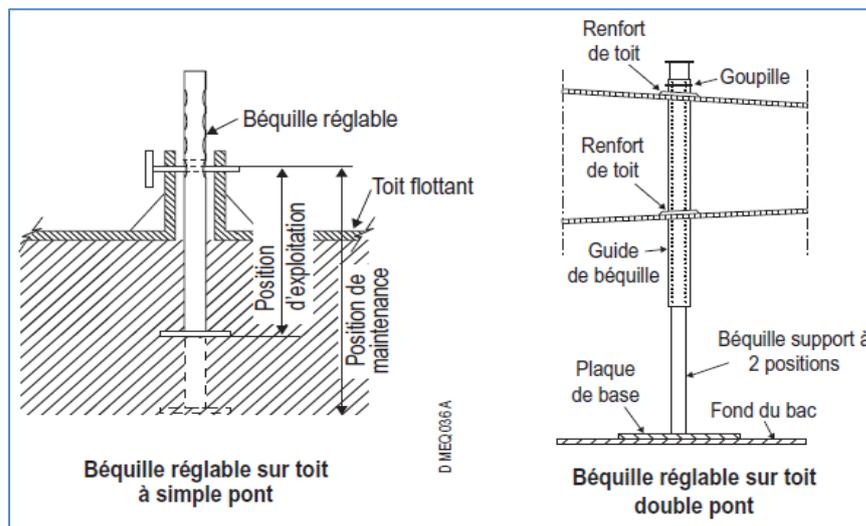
Béquille réglable sur toit à simple pont et toit double pont [3].
